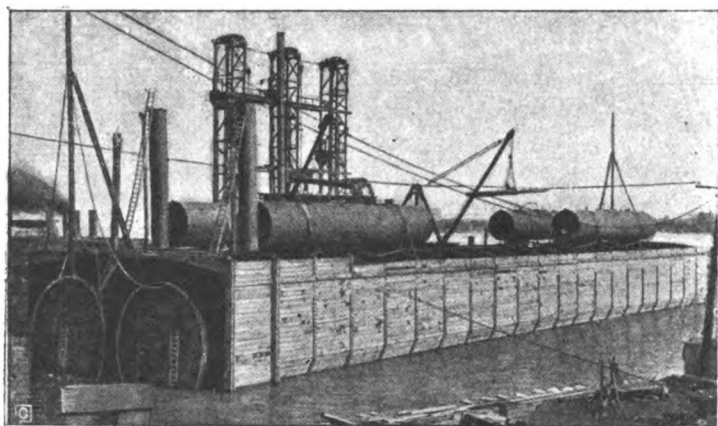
Tunnel sotto il Detroit River - Immersione di un tronco
